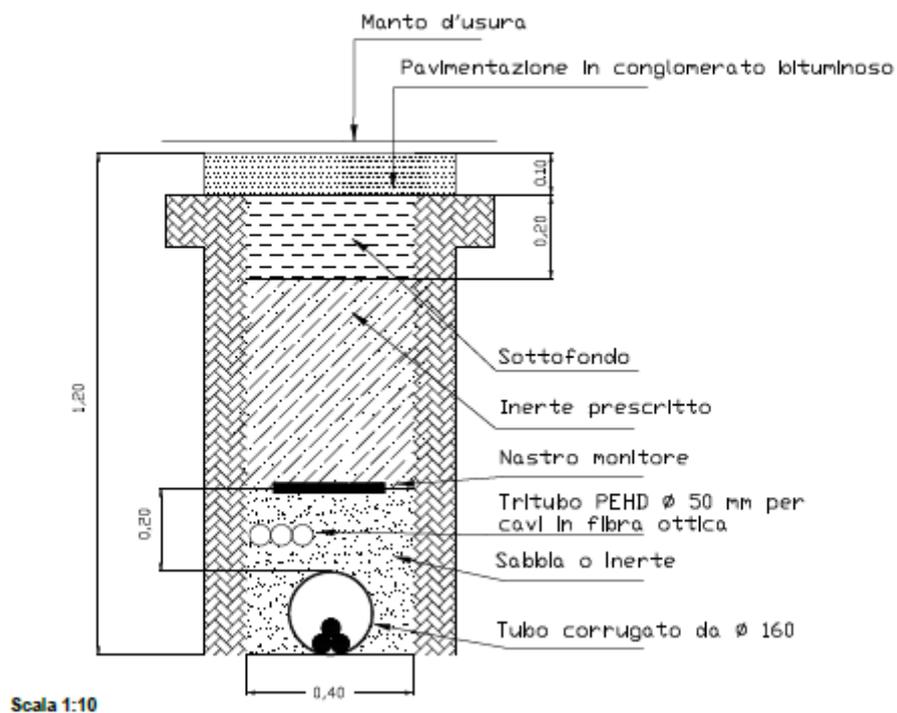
Sezione su strada asfaltata - posa di n°1 cavo MT
